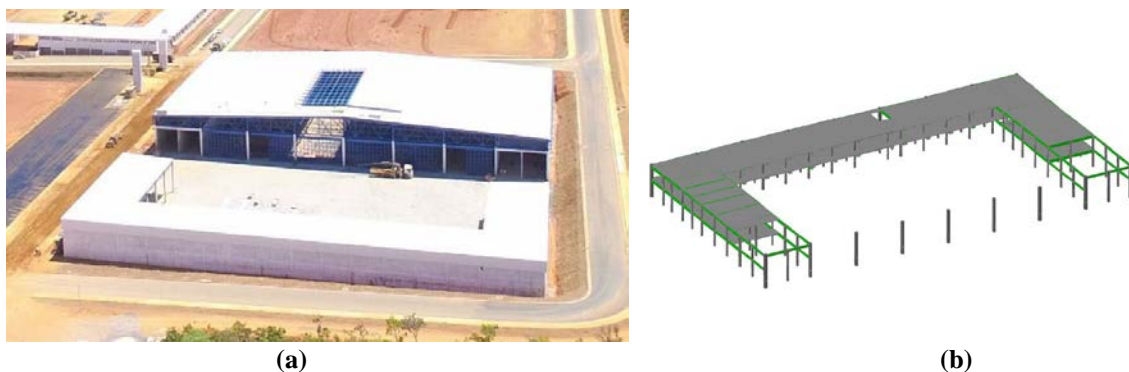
(a) Vista aérea do Hangar e da Garagem; (b) Modelo 3D da Estrutura de Concreto Pré-fabricado
